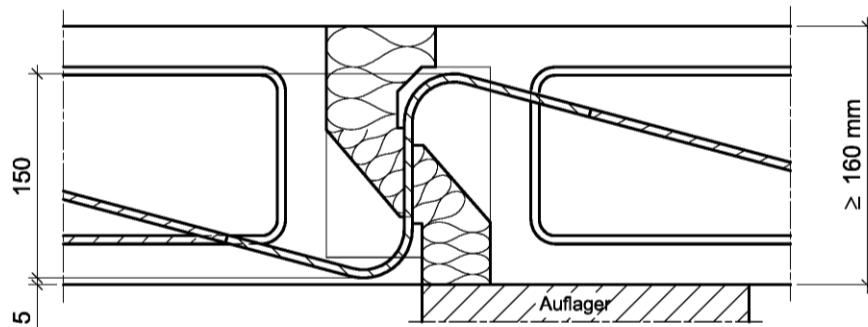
Beispiel Schöck Isokorb® Typ V mit Vertikalbewehrung
